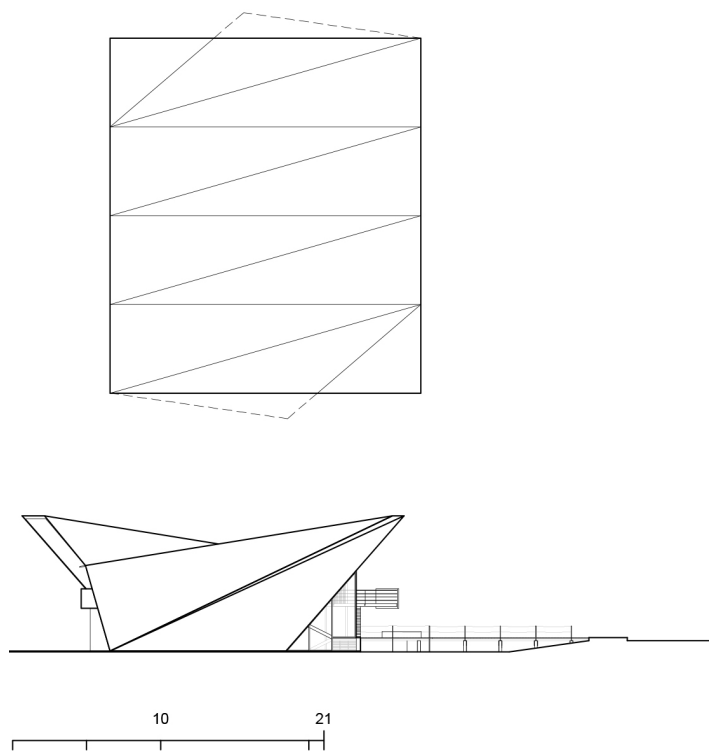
Cubierta desplegada de 21 x 24 m (en línea punteada los suplementos estructurales) y alzado este (fuente: El autor).
